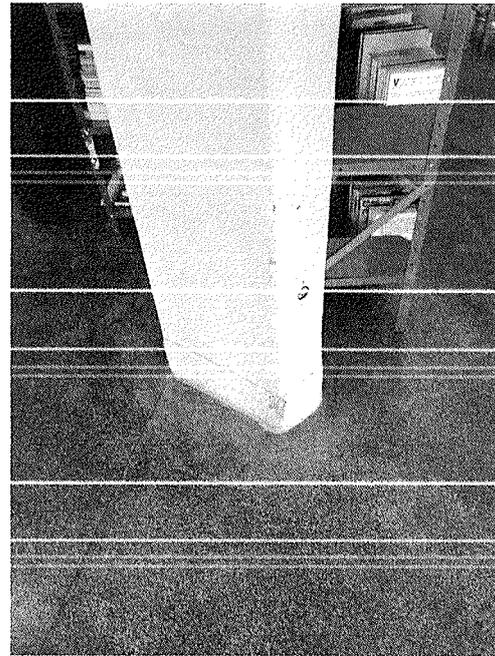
Descolamento do reboco na estrutura do hall de entrada
